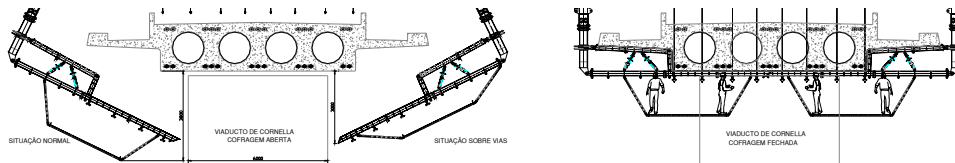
Cofragem do Viaduto de Cornella – Barcelona – Espanha
